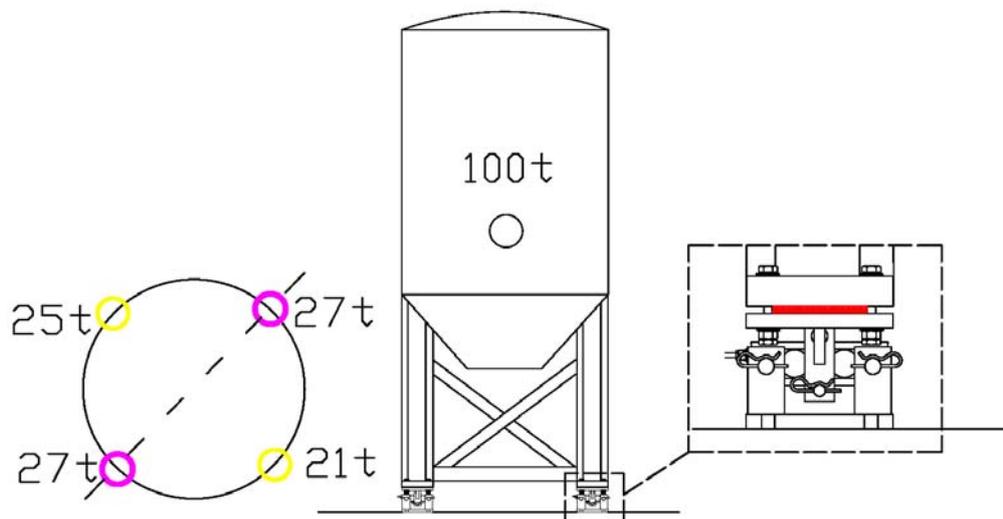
Vista de la planta y vista frontal de un Silo Nivelado
